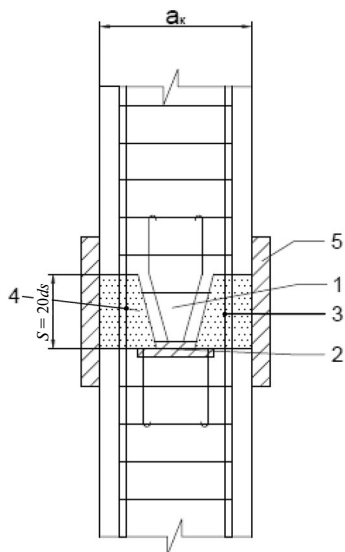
Стык сопряжения арматуры в сборных колоннах: 1 — бетонный зуб; 2 — опорные металлические пластины; 3 — сварной стык арматуры; 4 — бетон стыка колонны; 5 — опалубка
